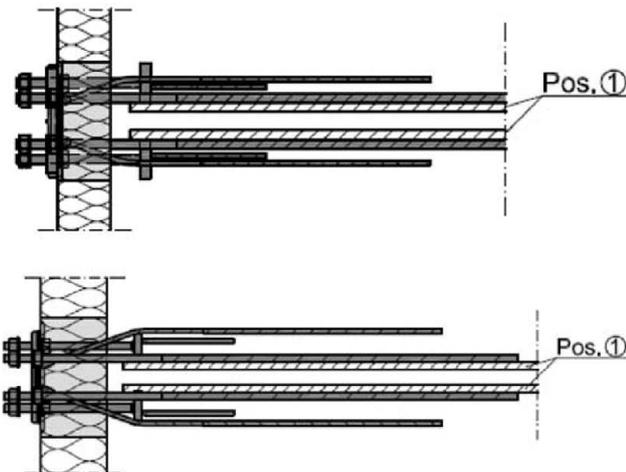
Draufsicht: Schöck Isokorb® T Typ SK-M1-V1, T Typ SK-M1-V2 und
